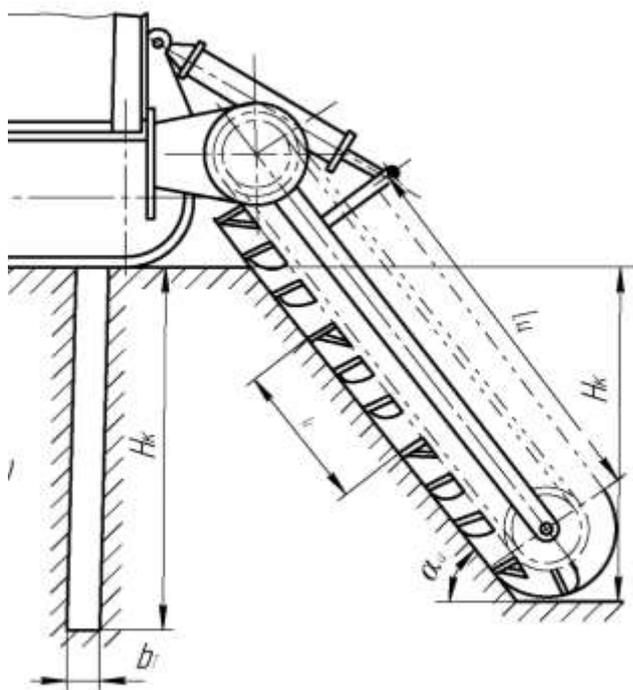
Схема машины со скребковым рабочим органом продольного копания, разрабатывающим грунт по раздельной схеме (тип V)
